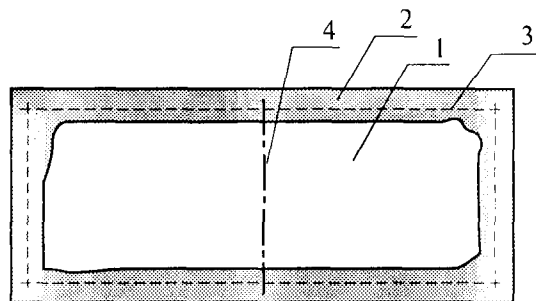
Принципиальная схема усиления простенка (столба, колонны) железобетонной облойкой
